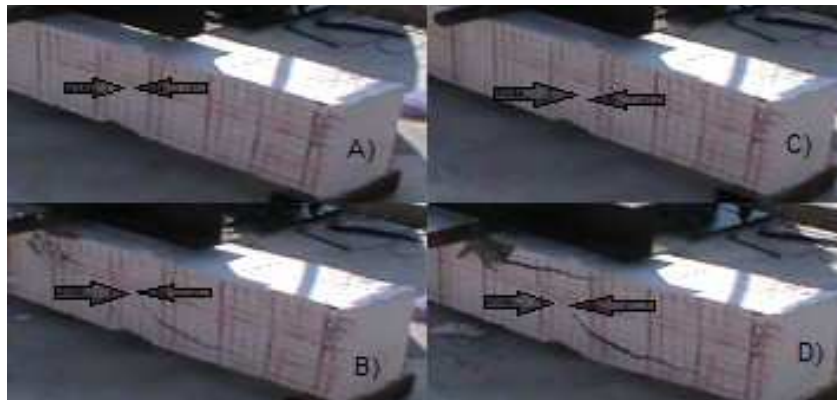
Patrón de grietas de la viga CRM3.
